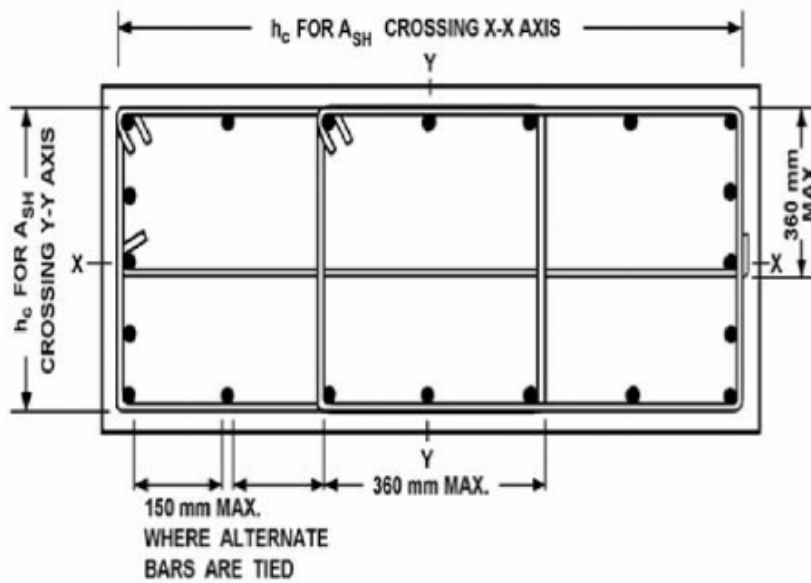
Detalhe exemplificativo das armaduras transversais do AASHTO [7]
